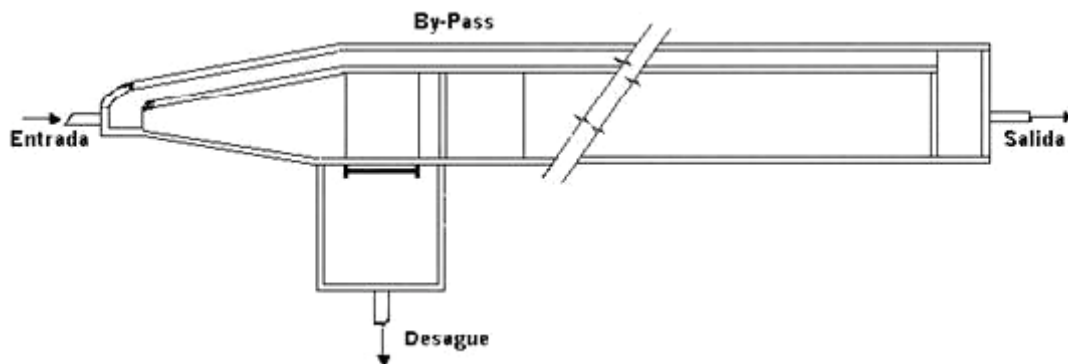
Desarenador de 1 unidad con by pass (planta).
